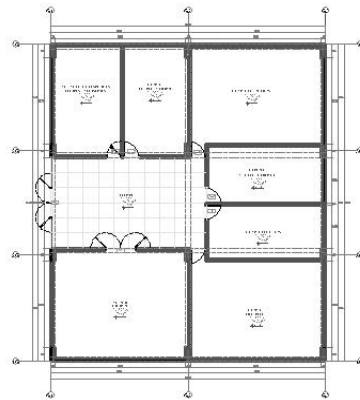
Plano modulo 04 primer nivel, cortes y elevaciones.
